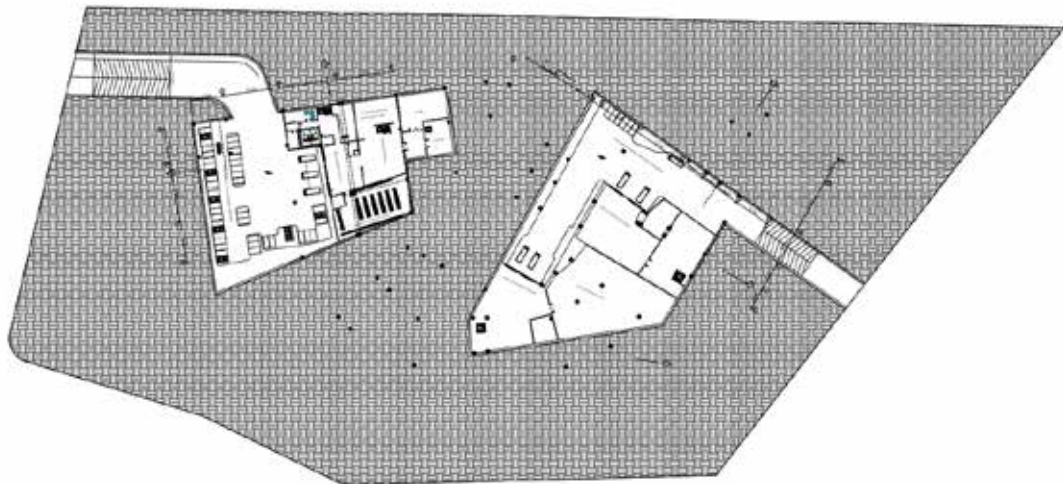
Plano Planta sótano de escuela de artes. (2017)
